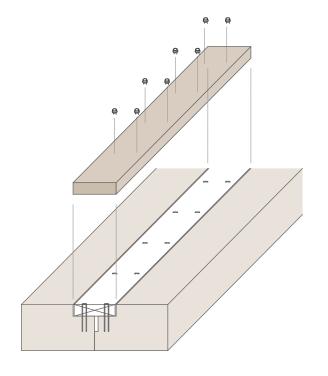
Detail Verbindung der Brettsperrholzelemente
